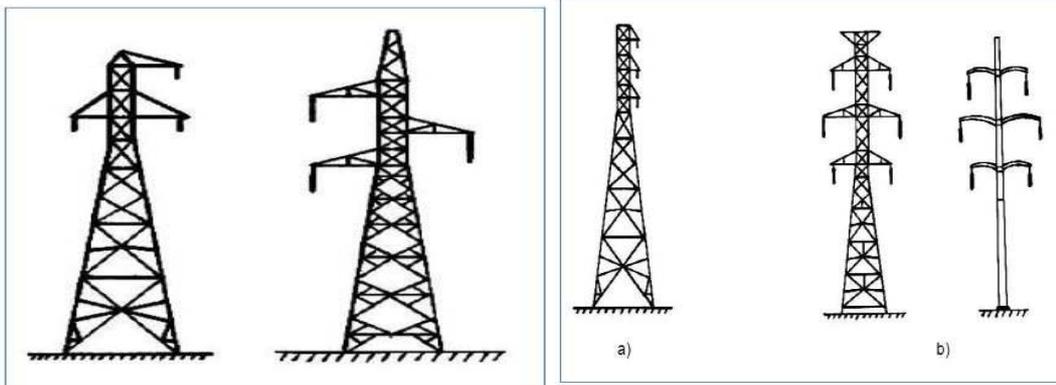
Armement quinconce. Figure1-4 : a. Armement en drapeau.
